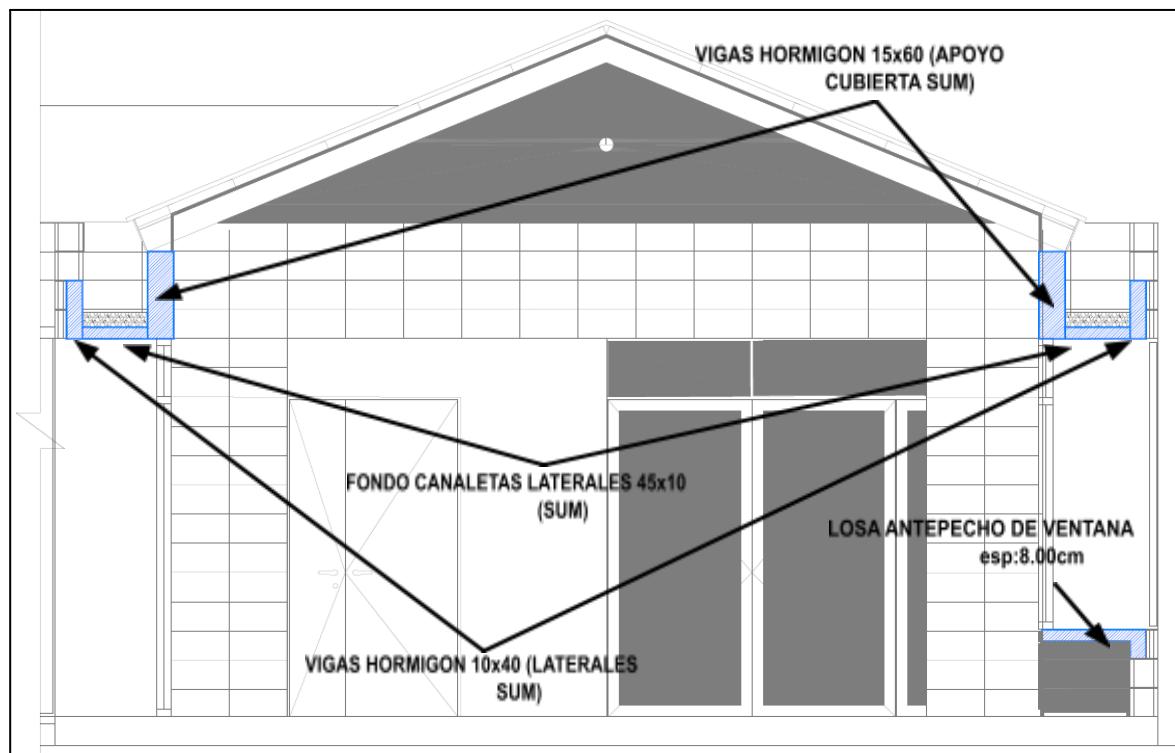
Esquema de secciones adoptadas para vigas de hormigón del SUM.
